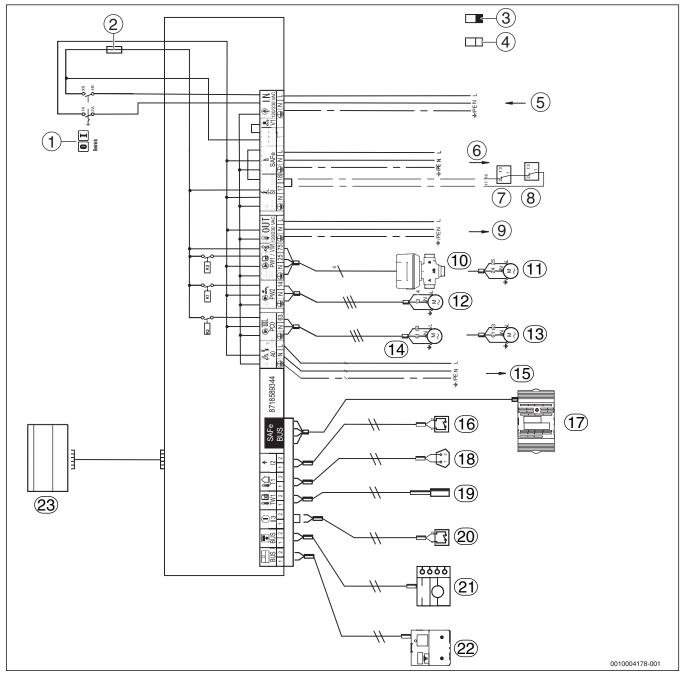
Schema di collegamento apparecchio di regolazione MX 25
